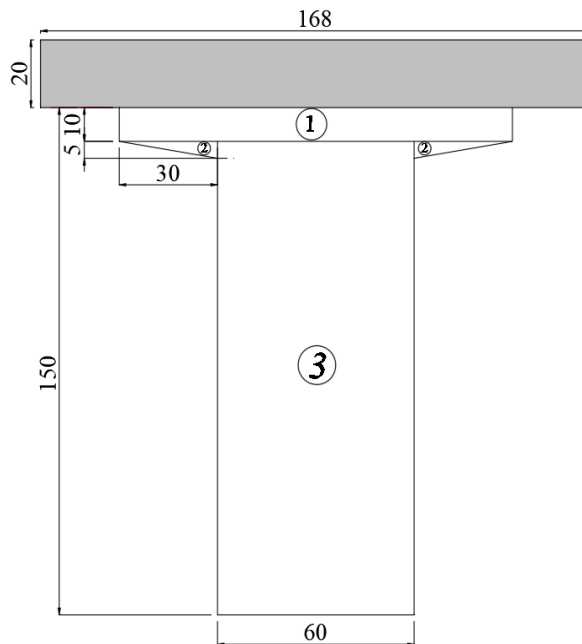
Section d'about de la poutre intermédiaire avec hourdis
